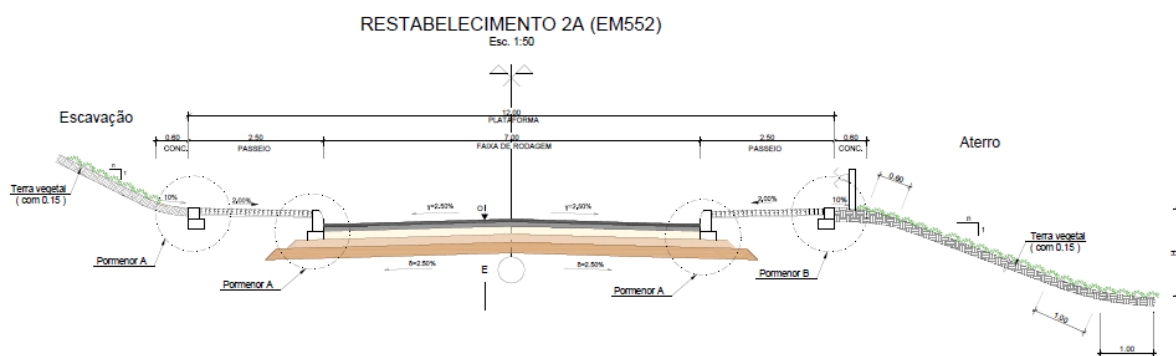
Perfil transversal tipo do Restabelecimento 2A
